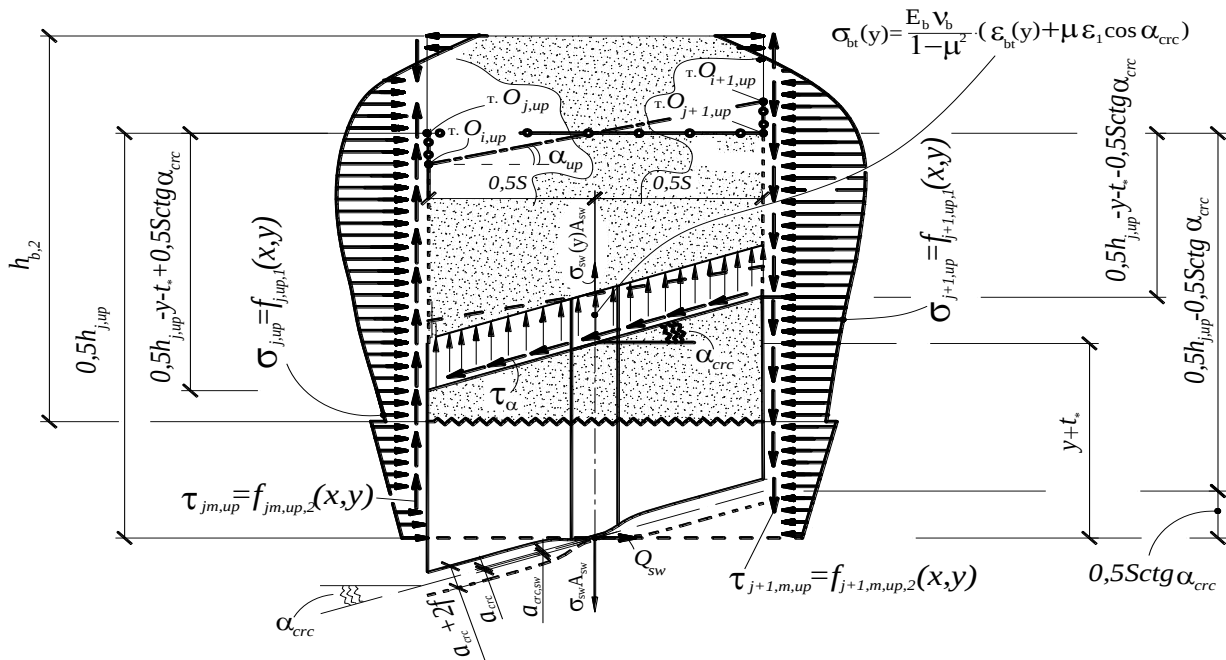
Уровневая модель для определения деформаций растянутого бетона $\varepsilon_b(z)$ вдоль оси поперечной арматуры на i -том уровне образования трещин, расстояния между трещинами и ширины их раскрытия в плосконапряженной железобетонной конструкции сплошного и составного сечения
